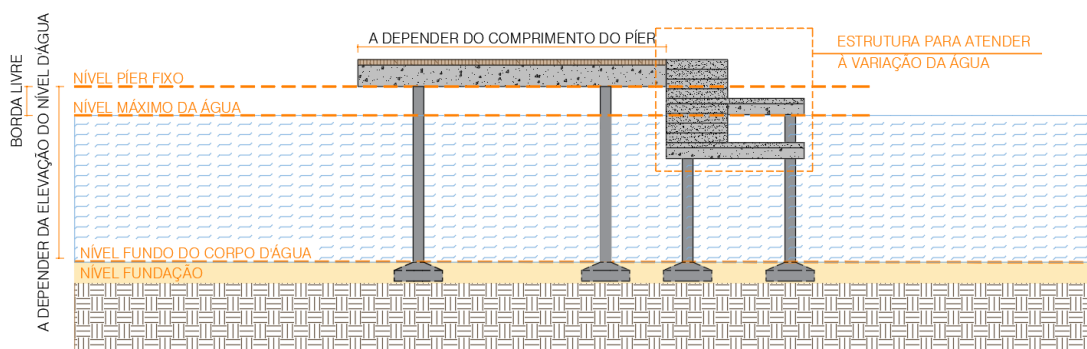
Vista frontal do projeto conceitual de um píer fixo de concreto e madeira
